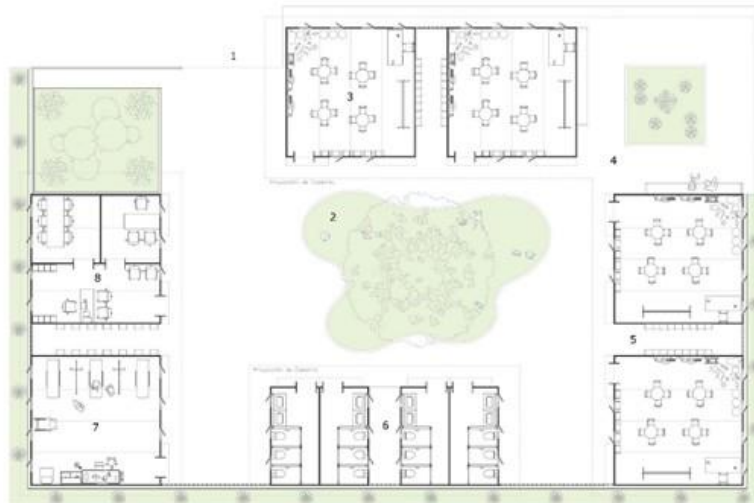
Planta arquitectónica del módulo base del prototipo. Fuente: Elaboración propia.
